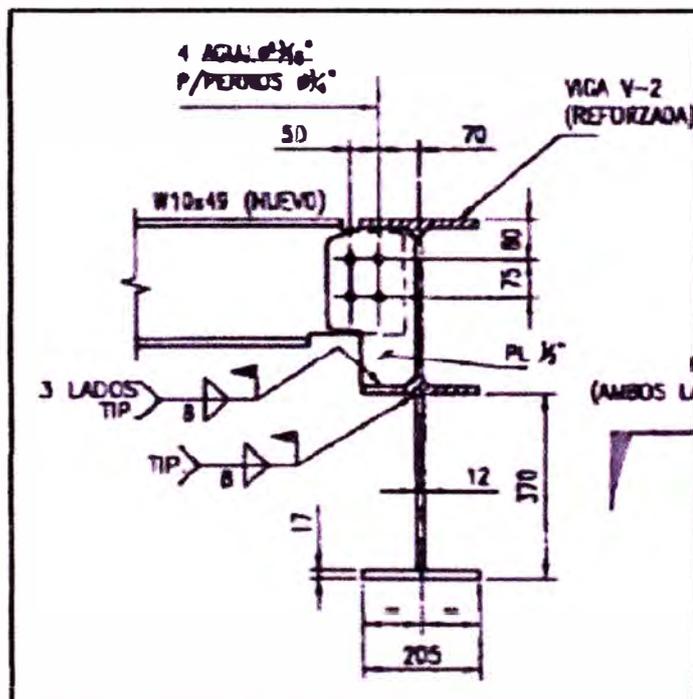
Corte para realizar el reforzamiento de la viga V-2
